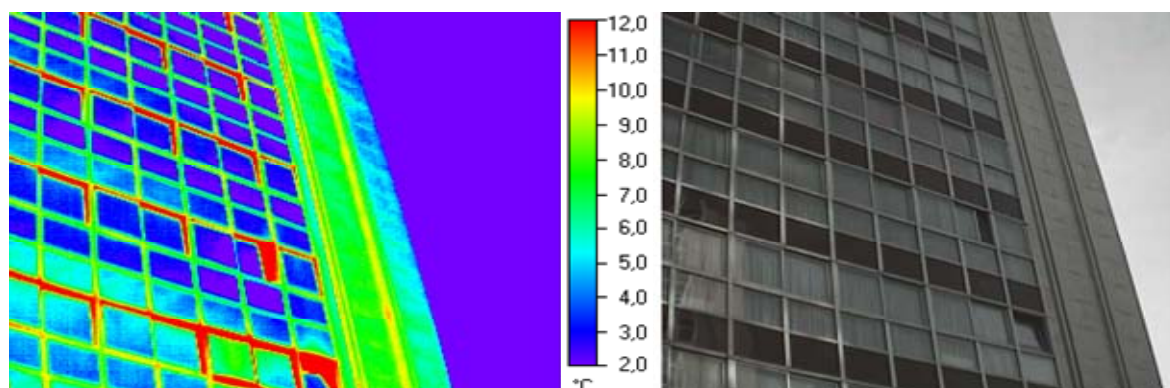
Cerramientos exteriores. Detalles perfiles muro cortina
